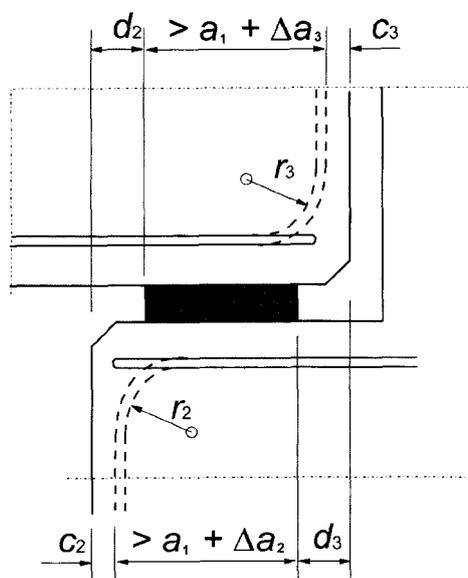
Beispiel der Bewehrungsführung am Auflager
